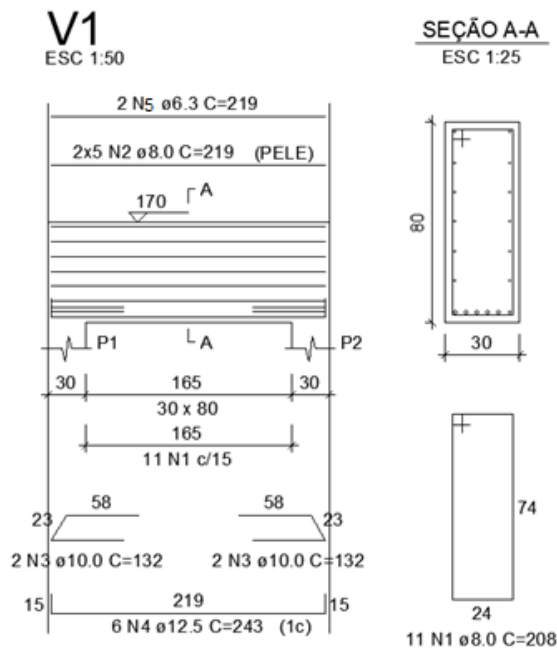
Viga modelada no Eberick – Detalhamento da viga.
